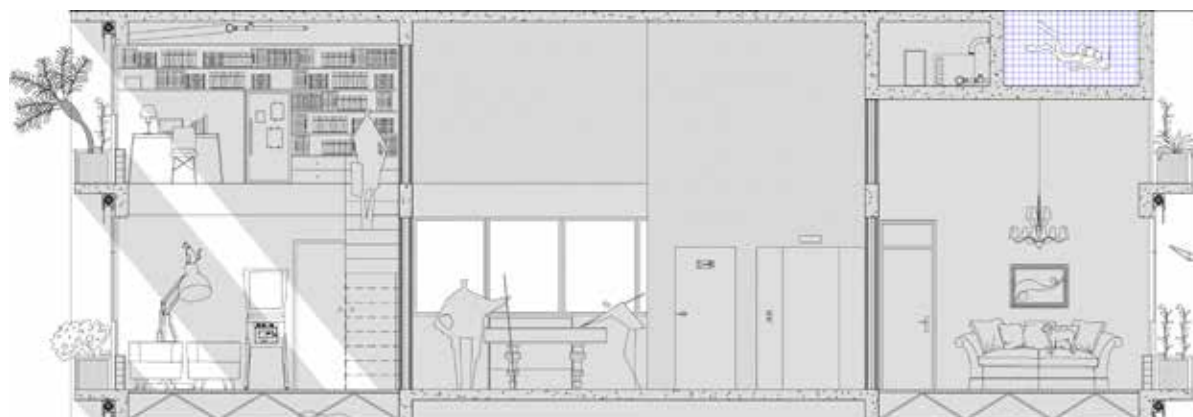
Corte transversal do sexto pavimento evidenciando a possibilidade de crescimento vertical com a construção de um mezanino.
